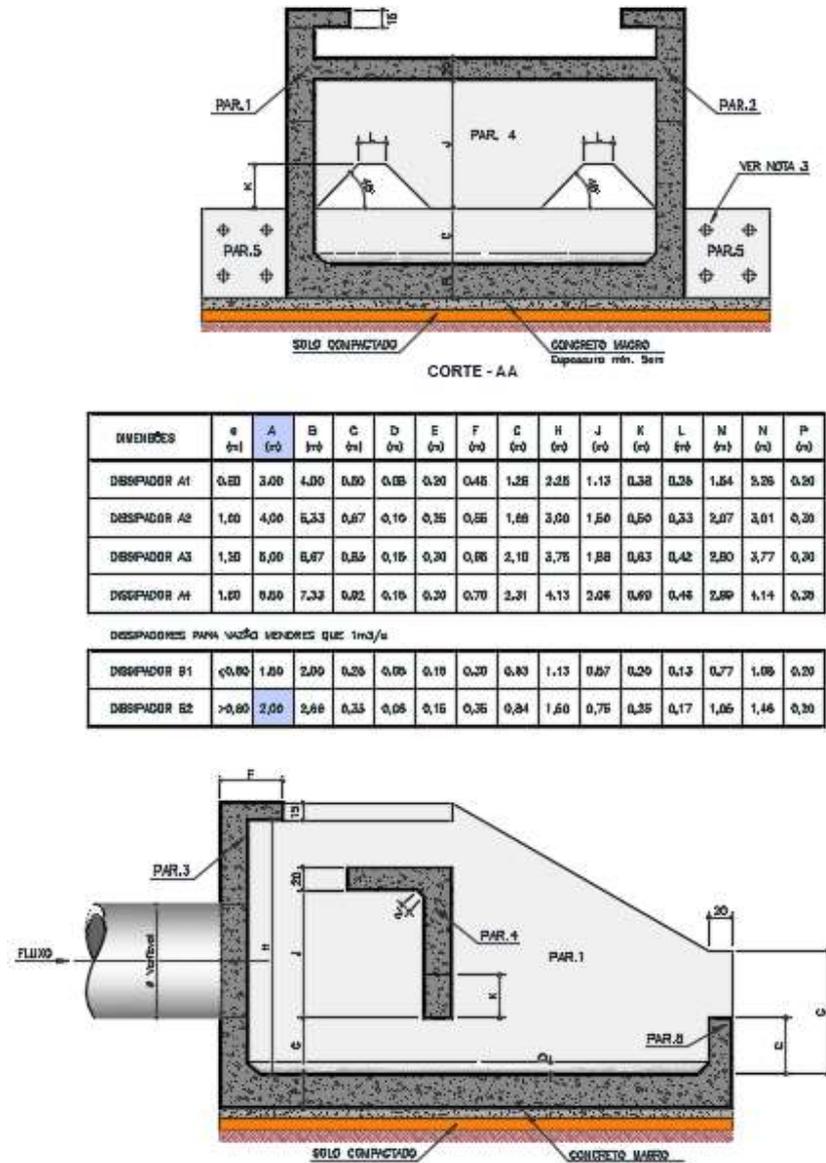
Detalhes Cortes e Tabela de Dimensões Dissipador
